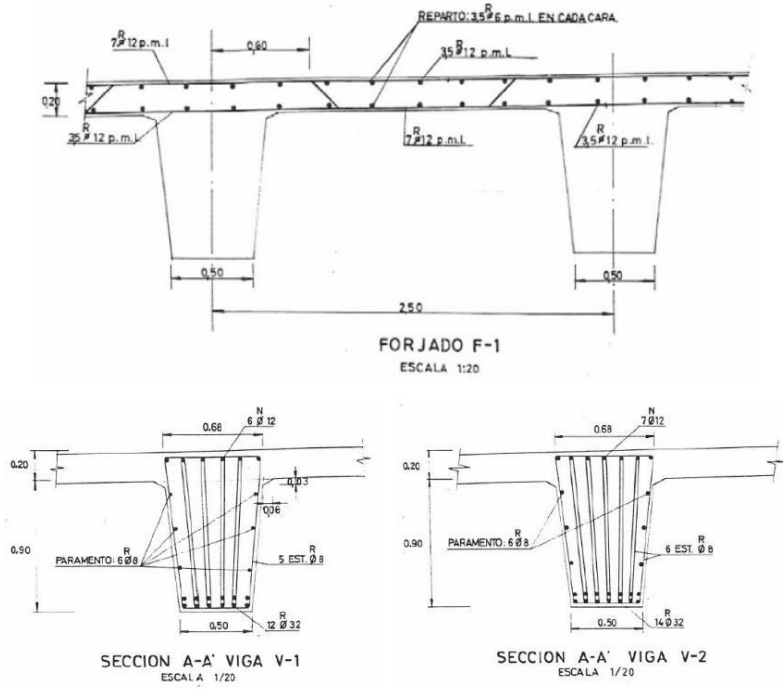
Detalles del armado de forjado y vigas de la planta -1 del aparcamiento
